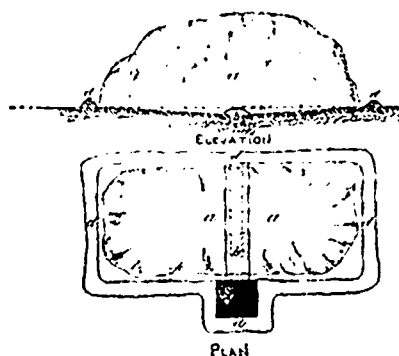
Coupe transversale et plan d'une plateforme étanche à arc concave pour le fumier.
